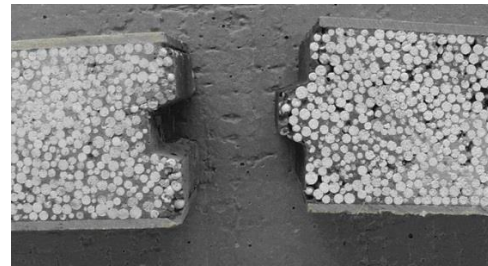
Ligação entre Painéis por encaixe trapezoidal.
